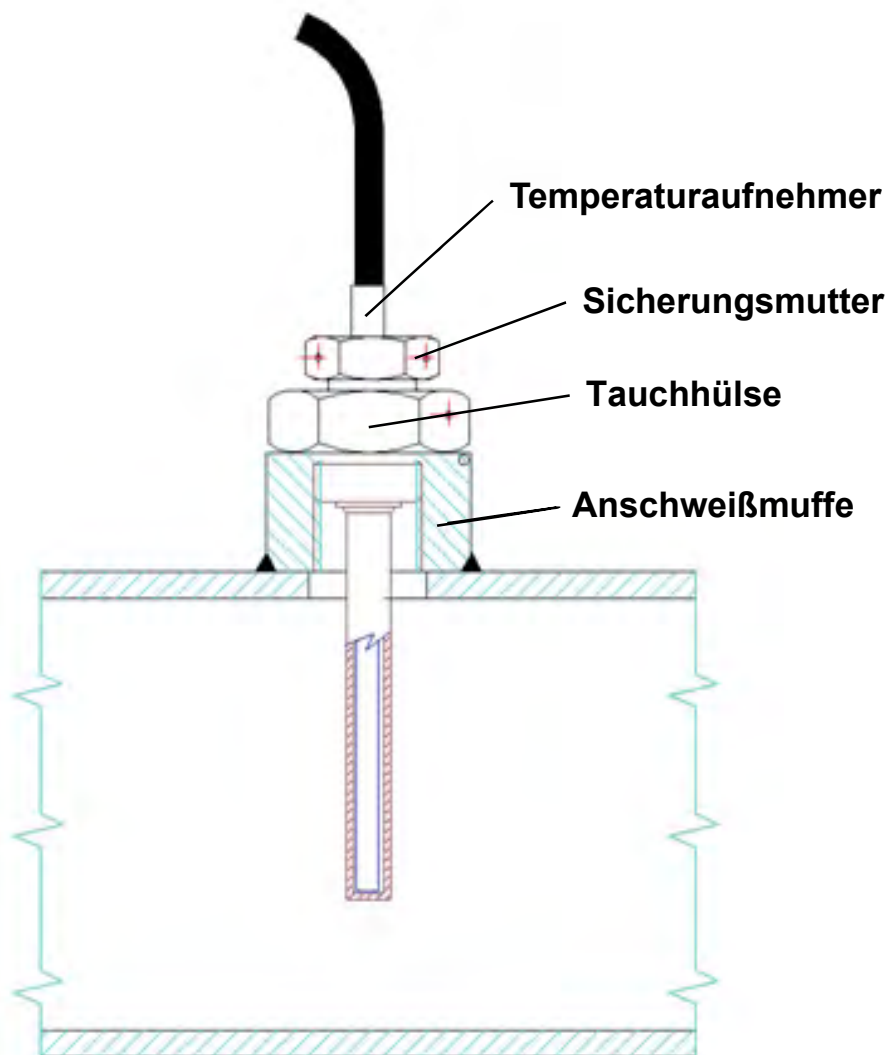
Montage des Temperatursensors mit Hilfe einer Schweißmuffe
